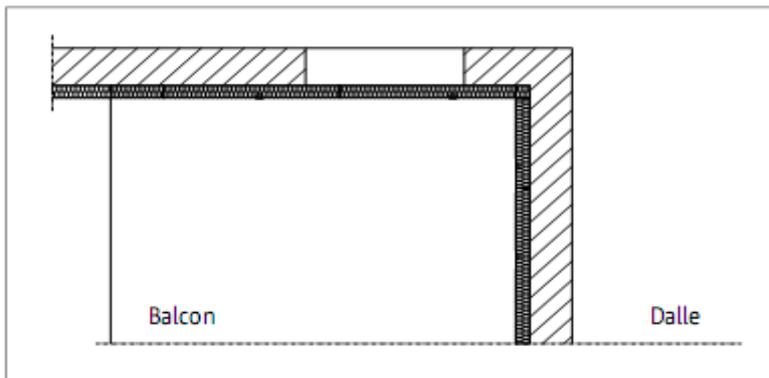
Balcon en béton armé appuyé sur deux côtés.
